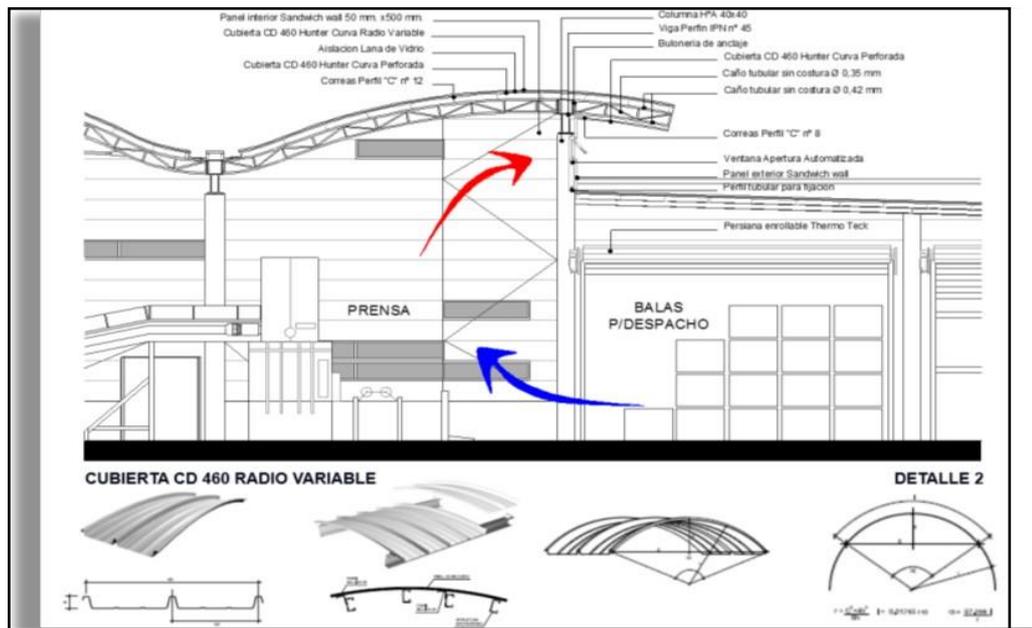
Estructura de la Planta de tratamiento de “RSU” con producción de energías renovables- empresa COGERSA
